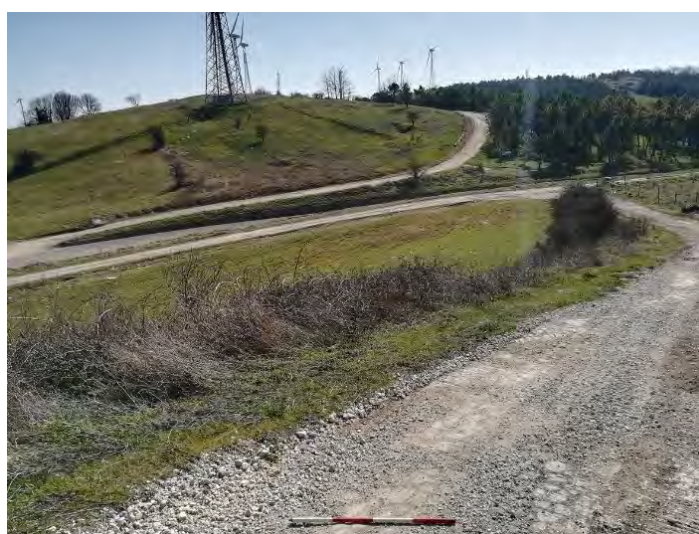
cavidotto in uscita da Mol02 verso il fondo del colle, attraversando SS369
